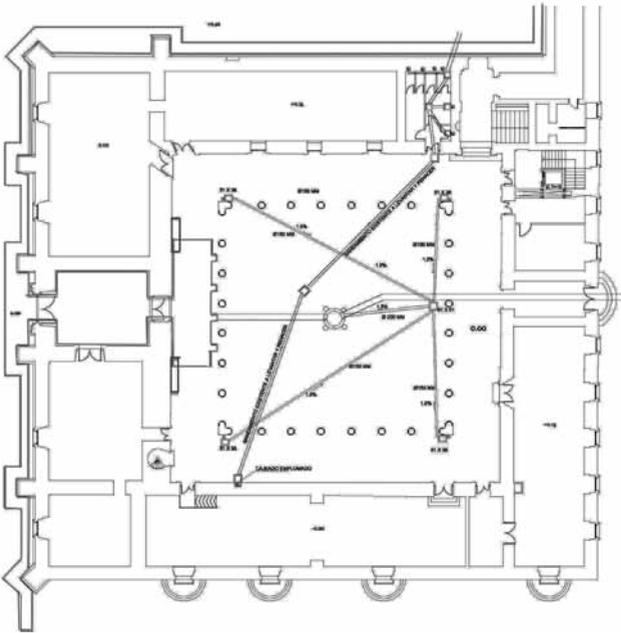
Palacio de Santa Cruz de Valladolid. Planta de acceso. Señalización del saneamiento y galerías de ventilación
